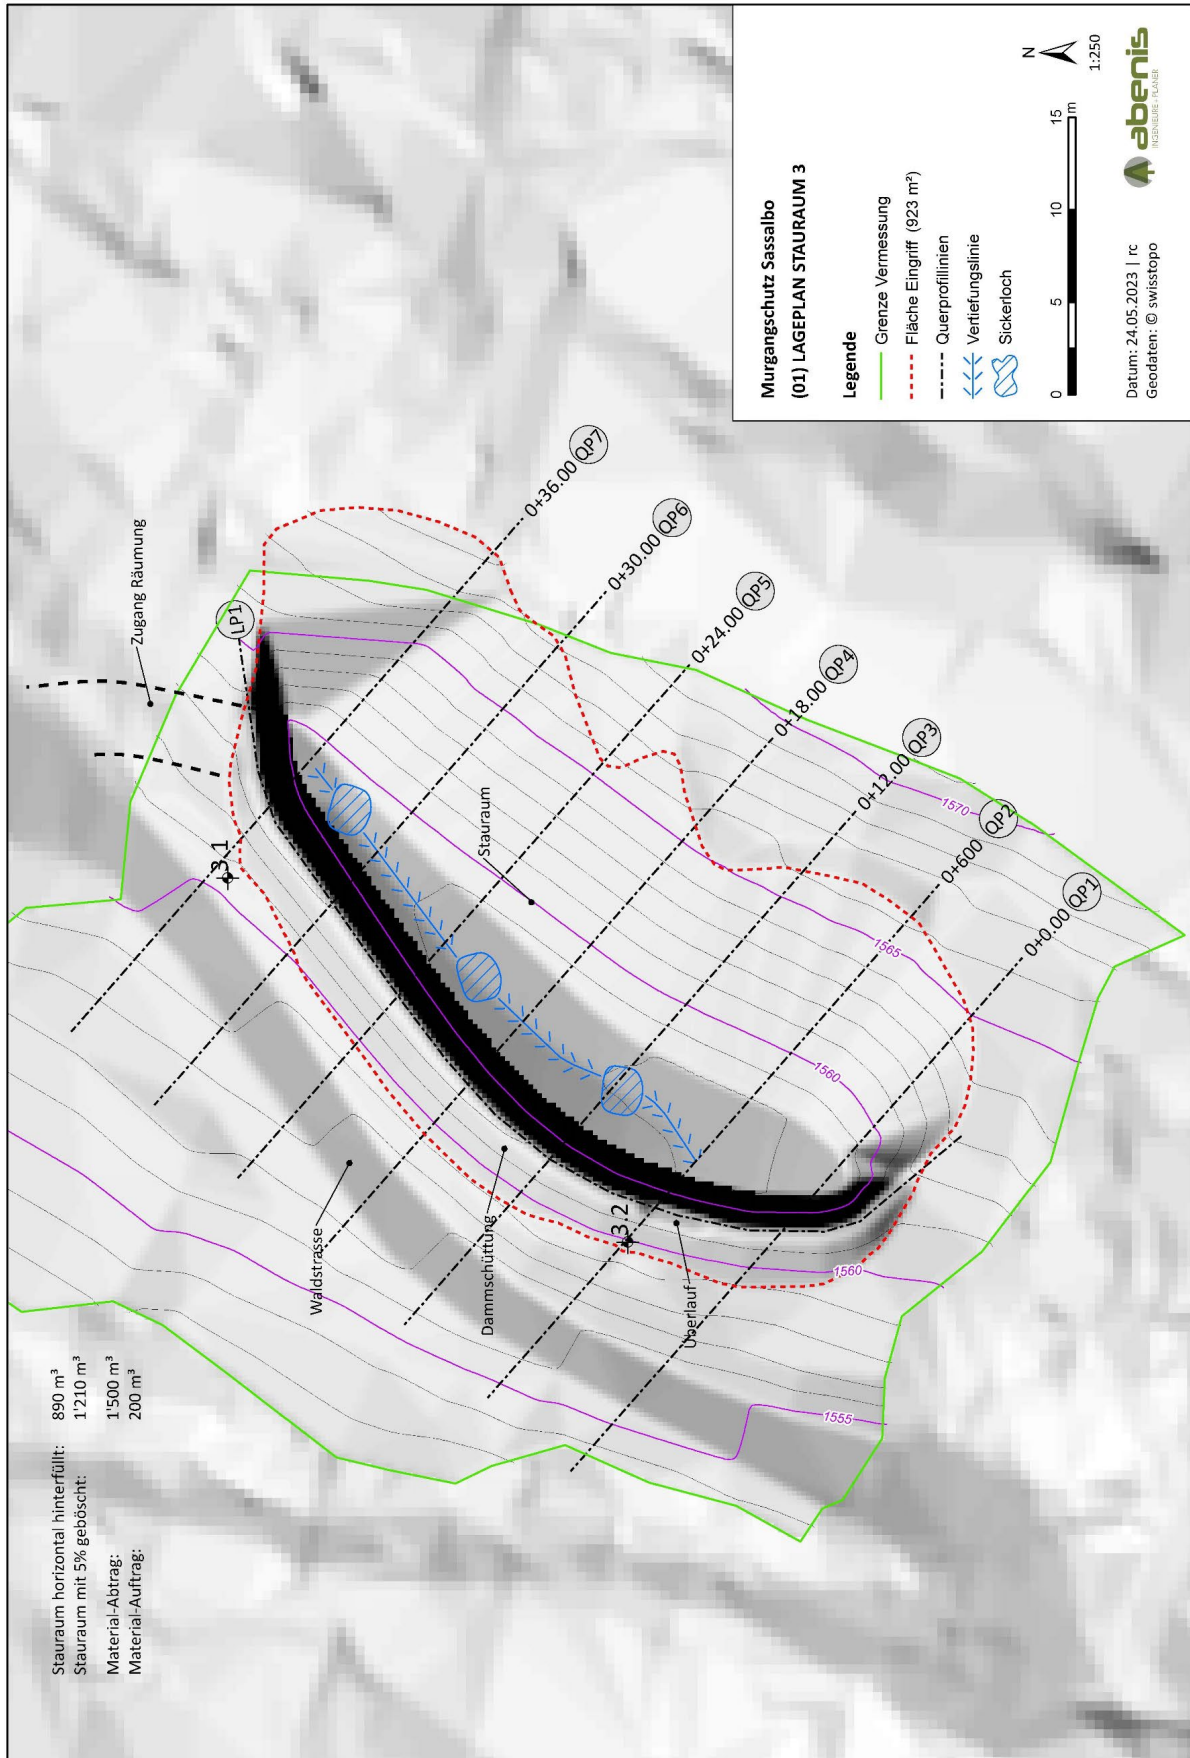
Lageplan Stauraum 3 an der Waldstrasse Paipidrin – Ross im Bosch d’Ain
